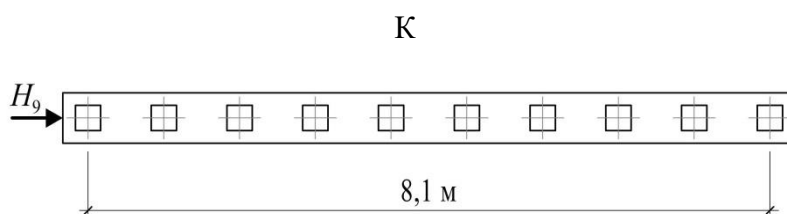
Схема горизонтально нагруженного ряда из 10 свай
